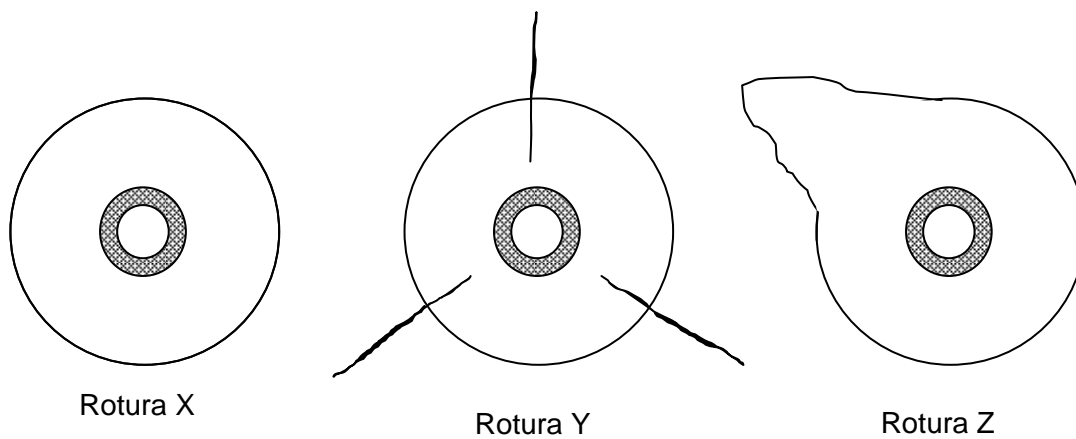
Tipos de roturas num ensaio Lok-test [44]
